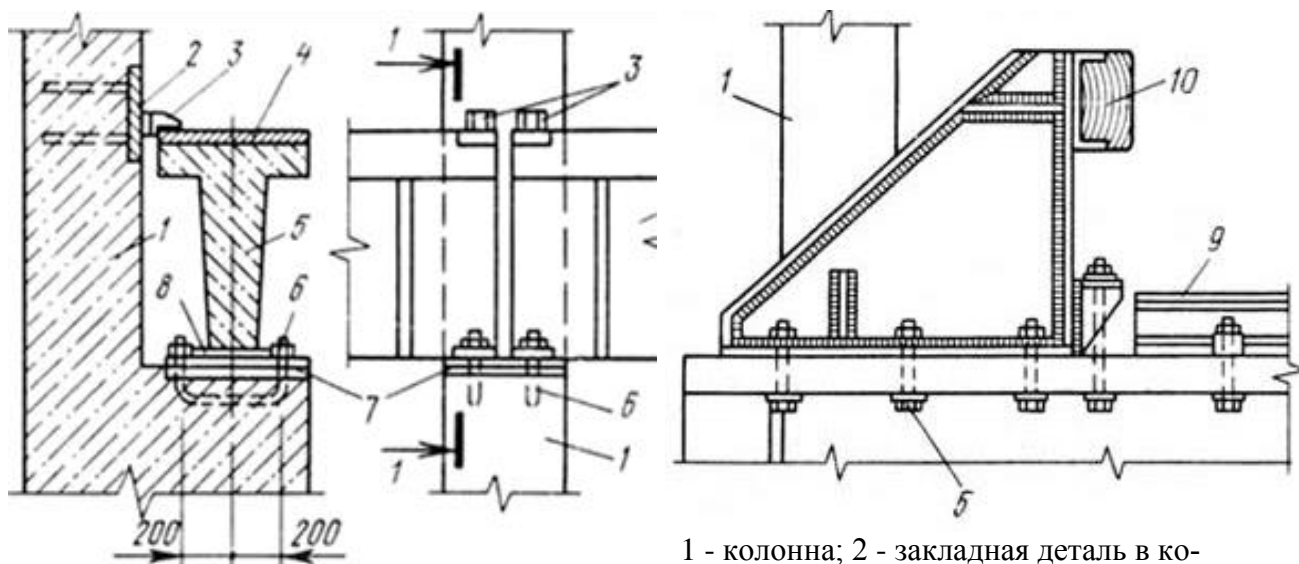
Сборные железобетонные подкрановые балки
